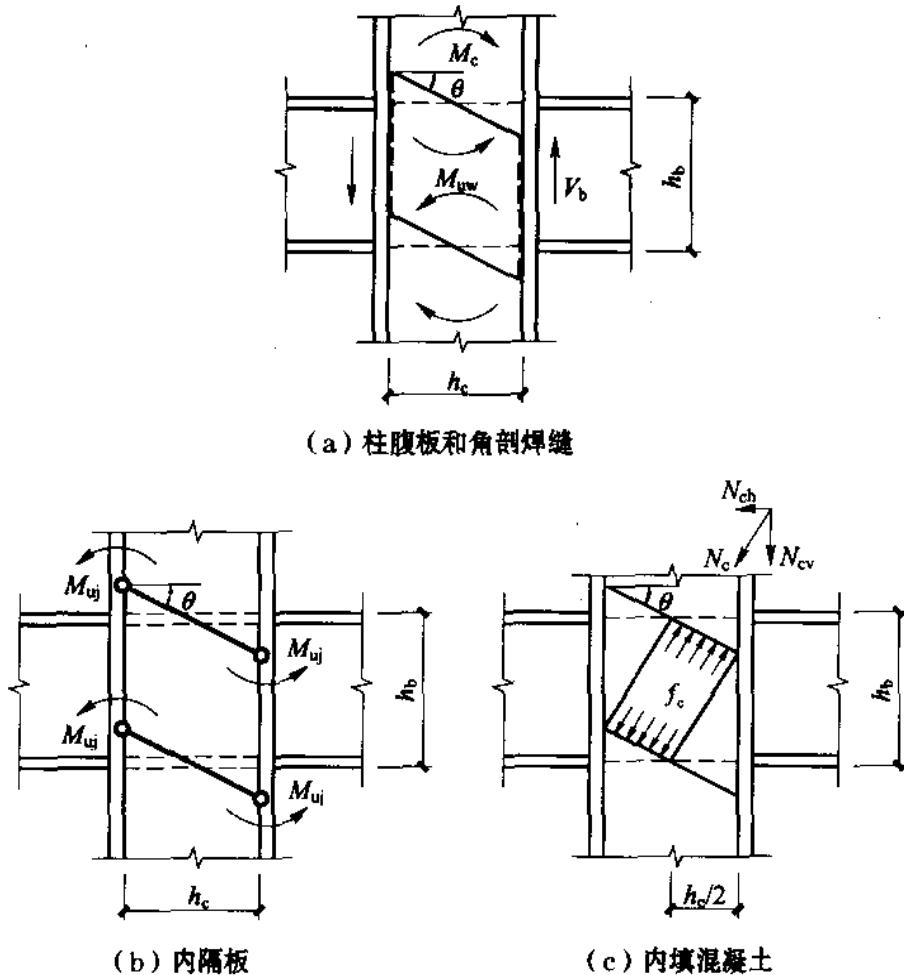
矩形钢管混凝土柱节点的屈服机制
